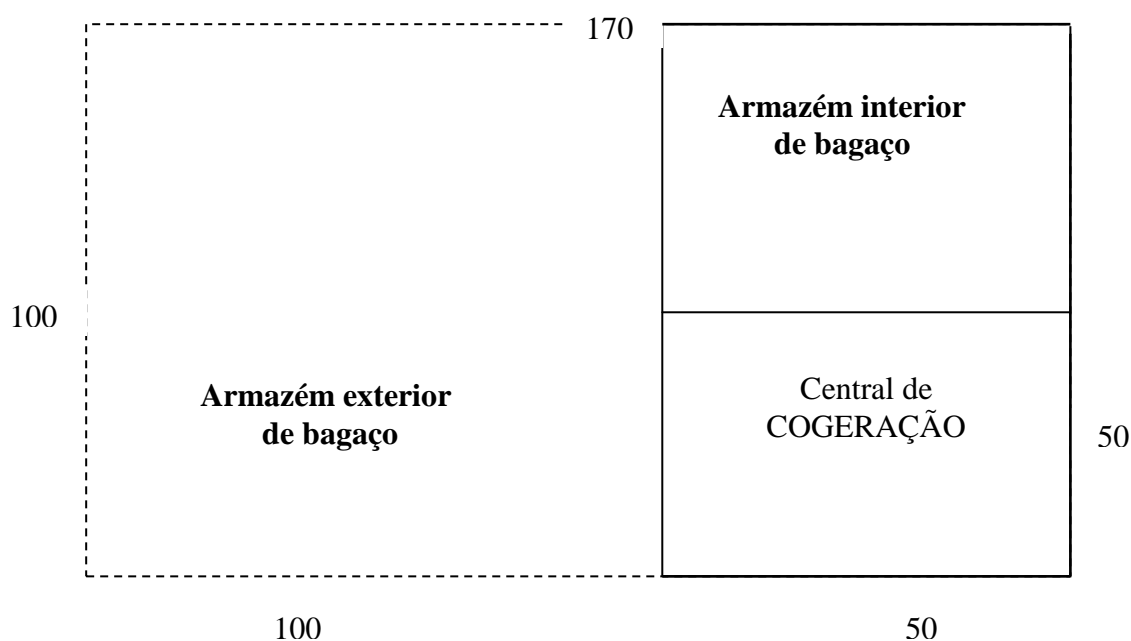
Planta com as áreas de implantação da central de biomassa para cogeração.
